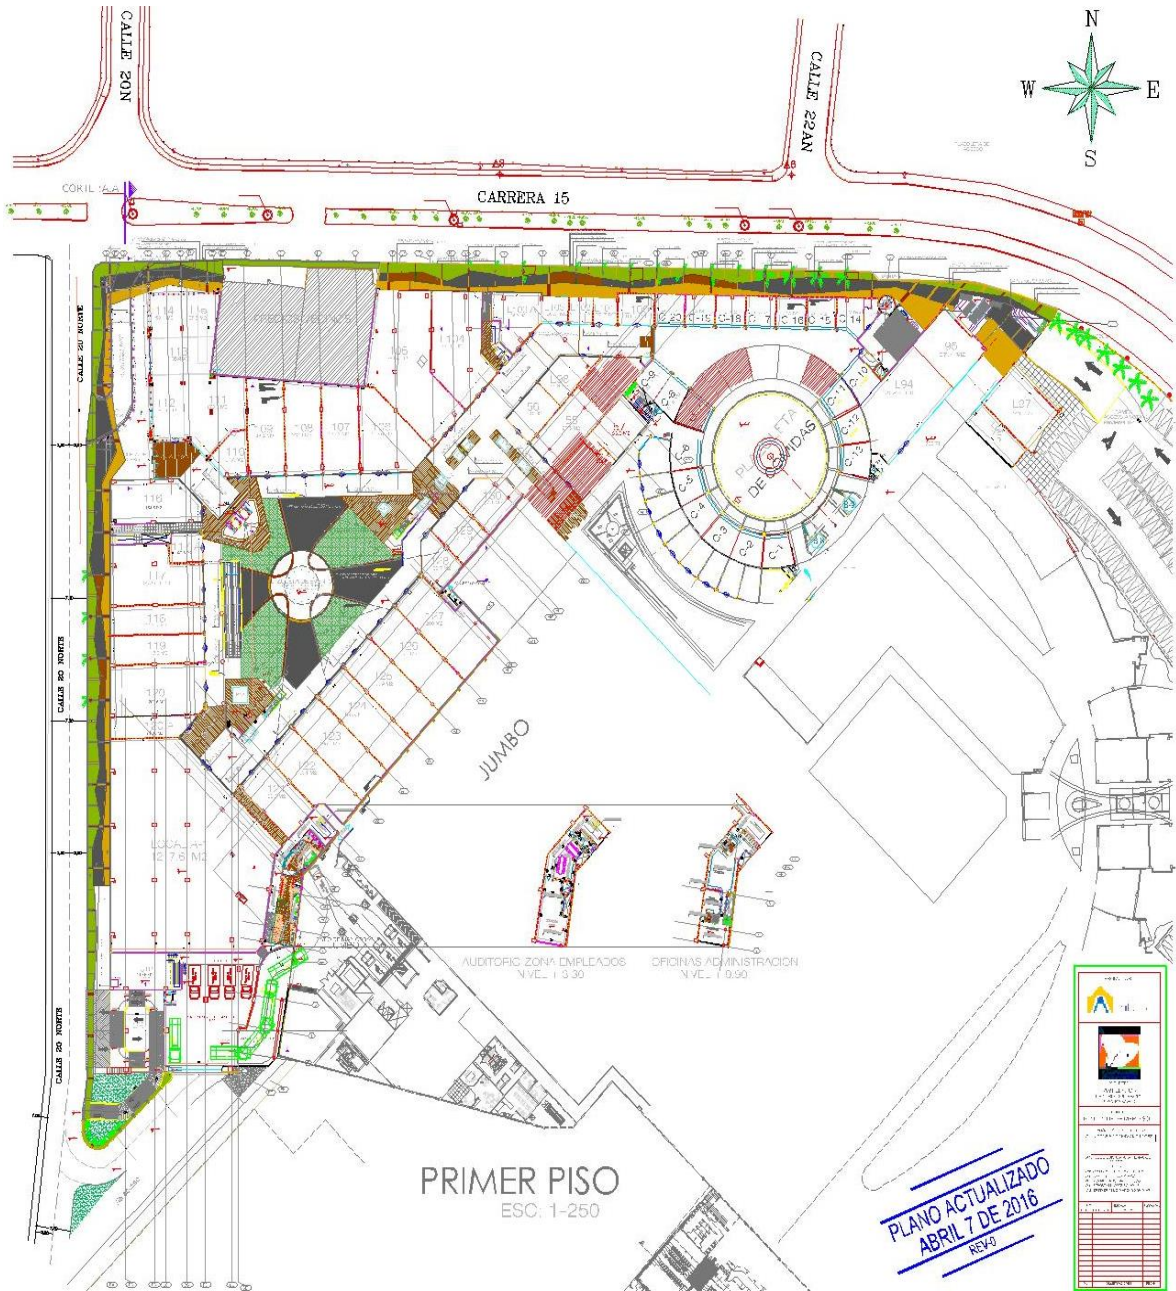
Planta arquitectónica, primero piso. (Fuente: Diseño arquitectónico ARINSA)
